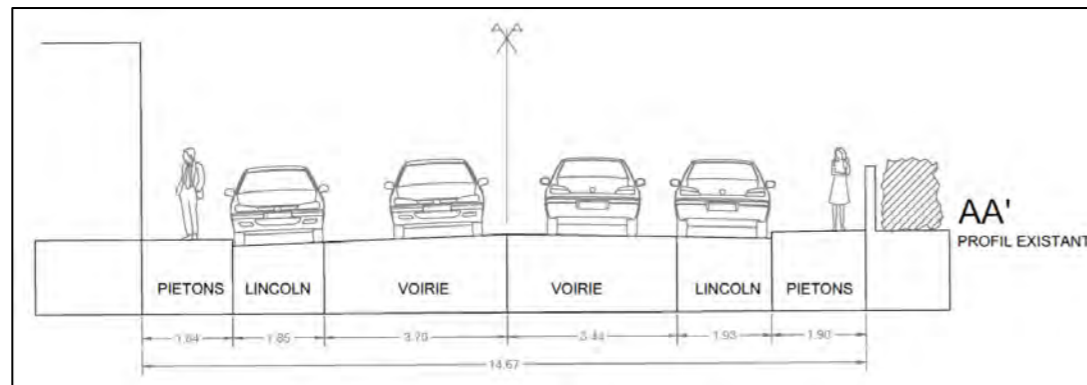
Profil en travers type existant entre la rue des Lauriers et l'allée des Platanes
